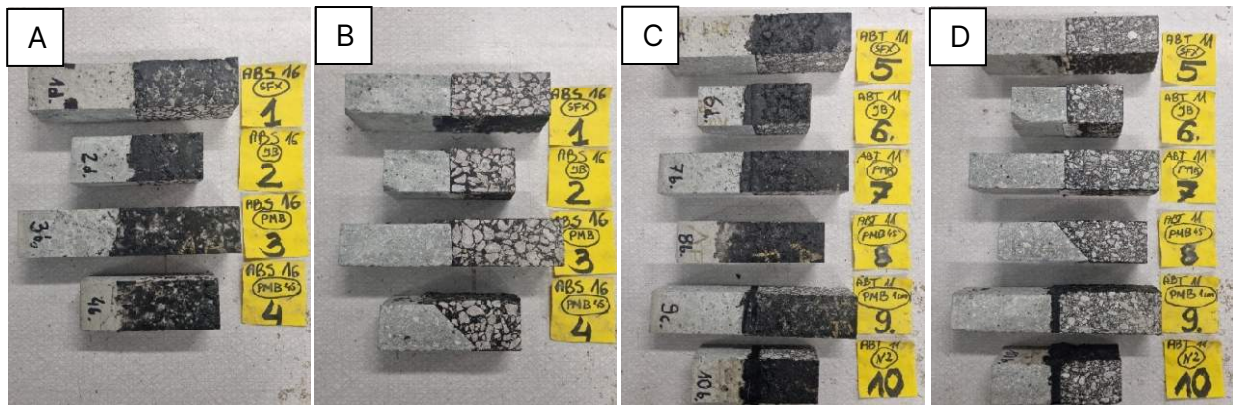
Exempel på sågning av plattor till balk-prover med dimensioner 50x50x350 mm. Foto: Patryk Witkiewicz.
